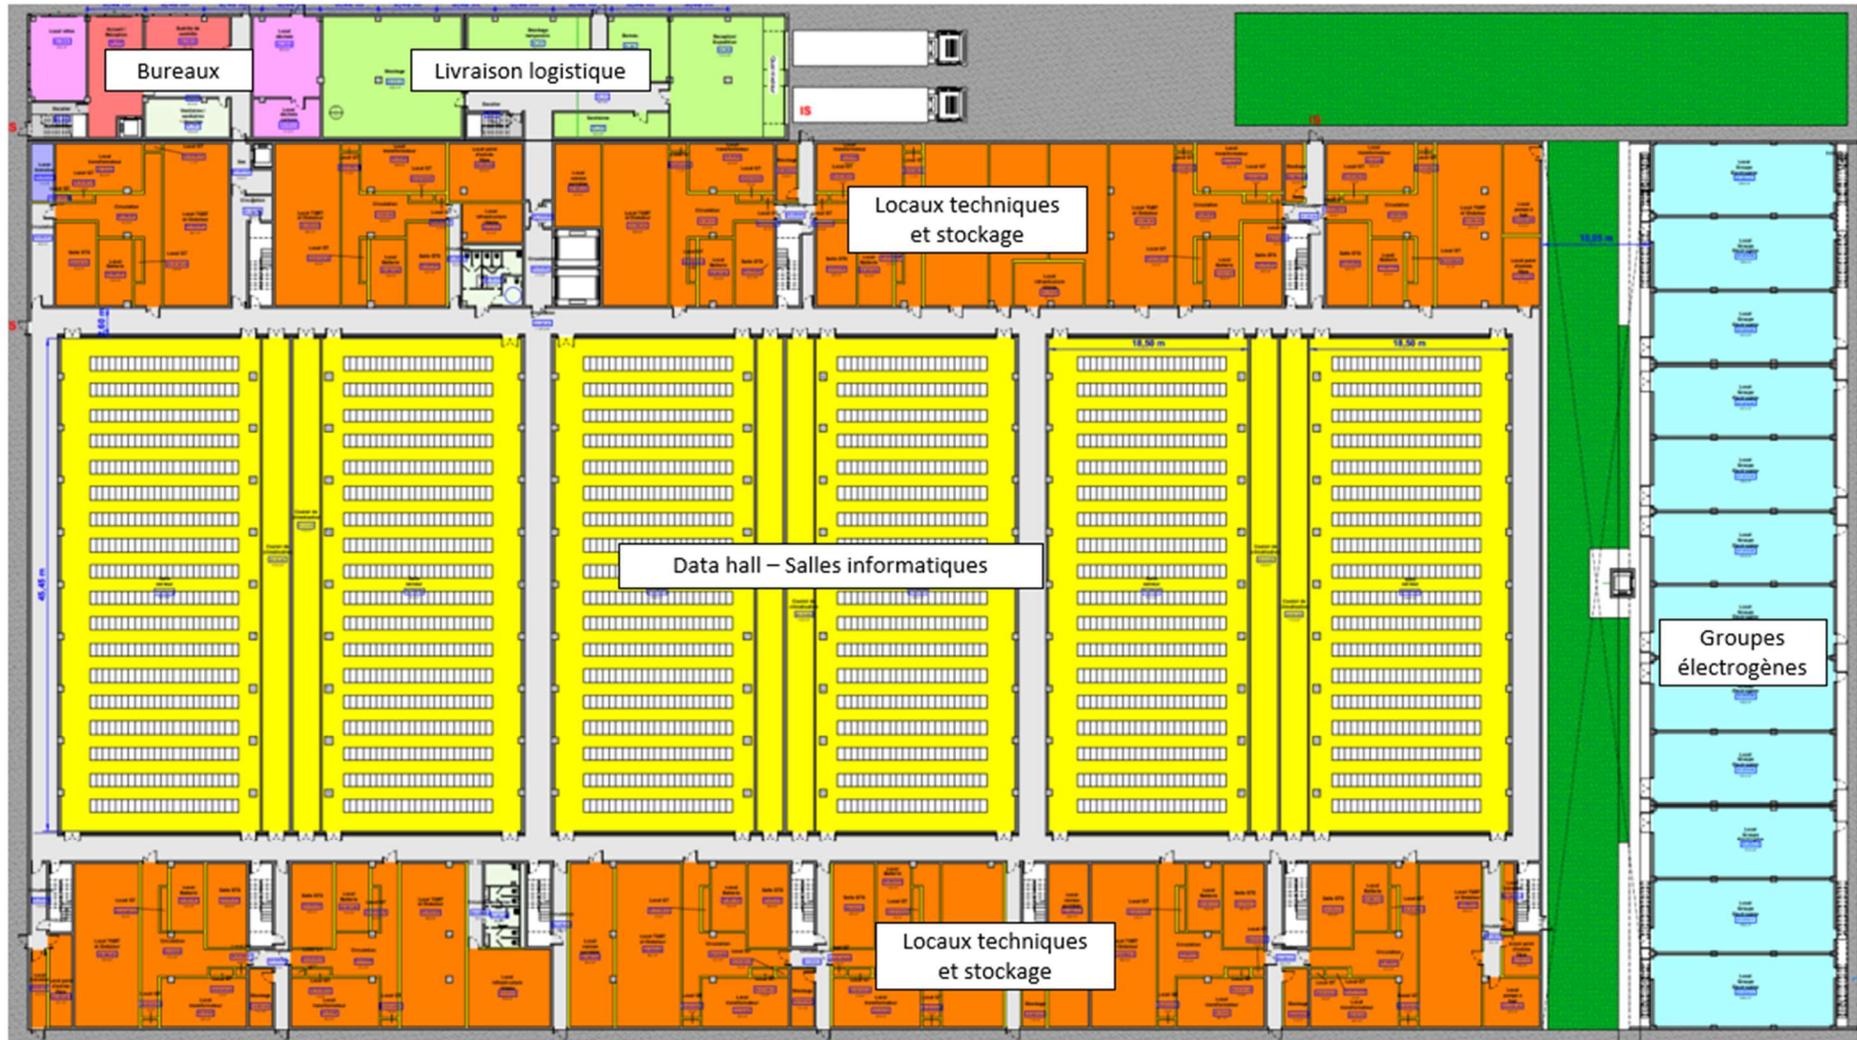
Plan du rez-de-chaussée des bâtiments principaux (source : ENIA)
